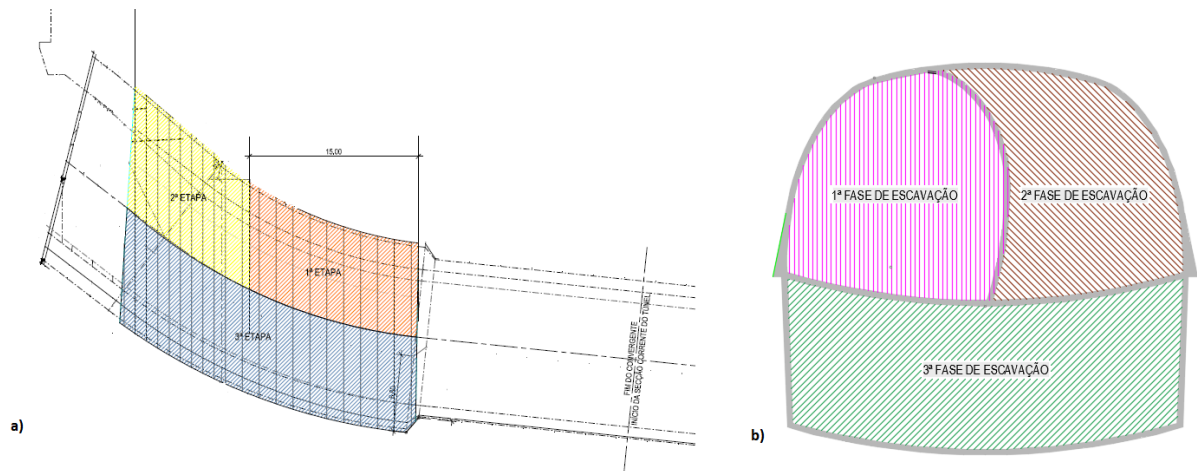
Faseamento construtivo do desmonte do rolhão. a) corte longitudinal; b) corte transversal a meio rolhão [66].
